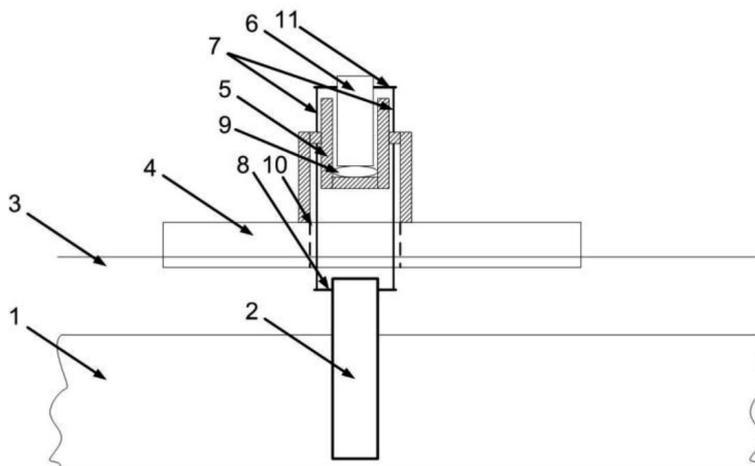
Принципиальная схема установки, извлекающей сваю из донного грунта, где 1 – донный грунт, 2 – свая, 3 – поверхность воды, 4 – понтон с отверстием в центре, 5 – артиллерийское орудие с креплением к понтону, 6 – поршень, 7 – трос, 8 – крепежный элемент в свае, 9 – камера с порохом, 10 – отверстие в понтоне, 11 – крепежный элемент в поршне
